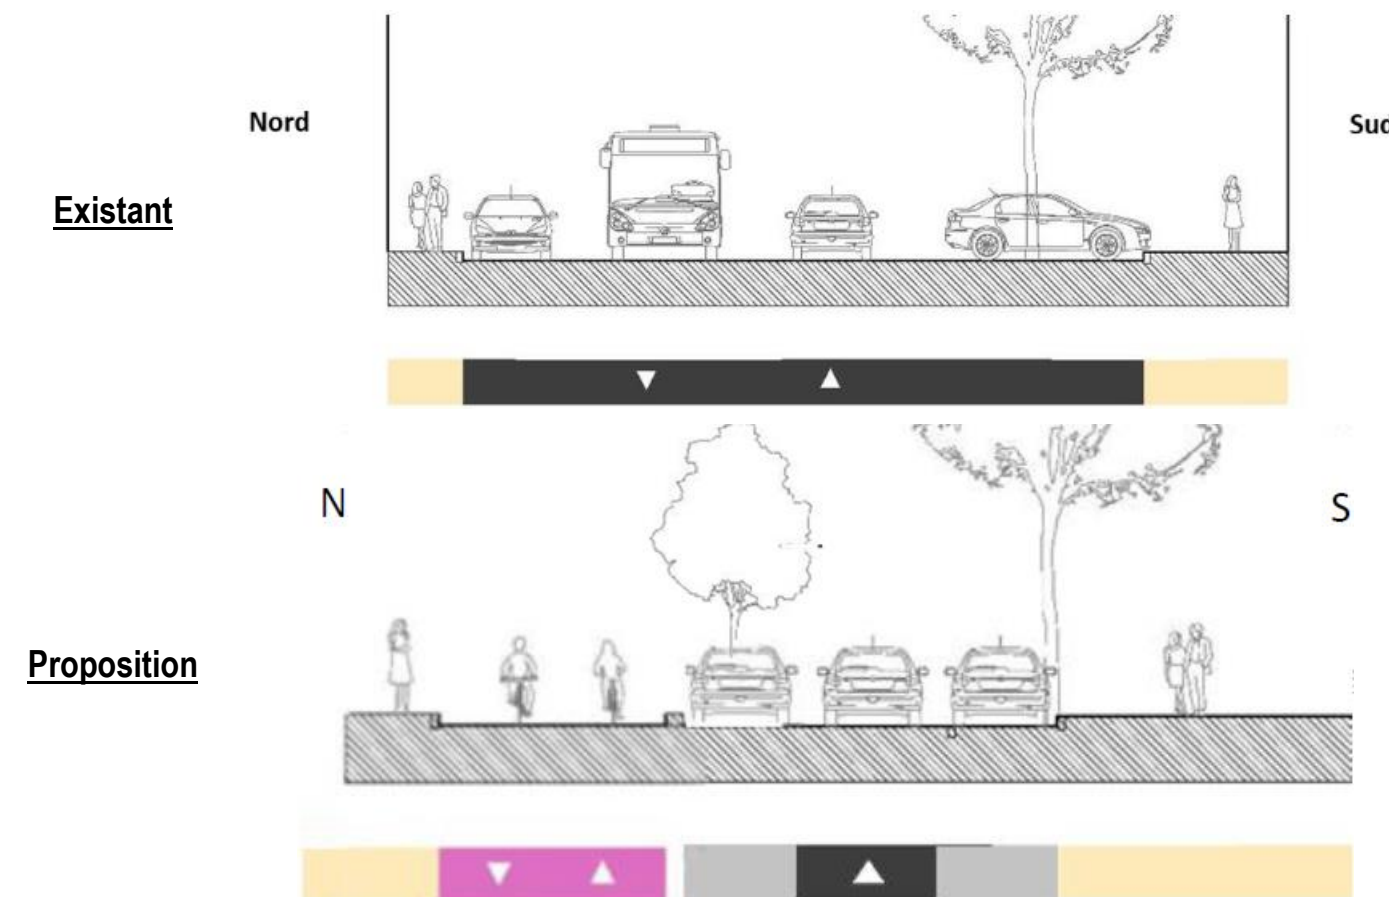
Coupes de l'existant et du projet secteur Hachette-Dauphiné, Section b : Rue Renoir
